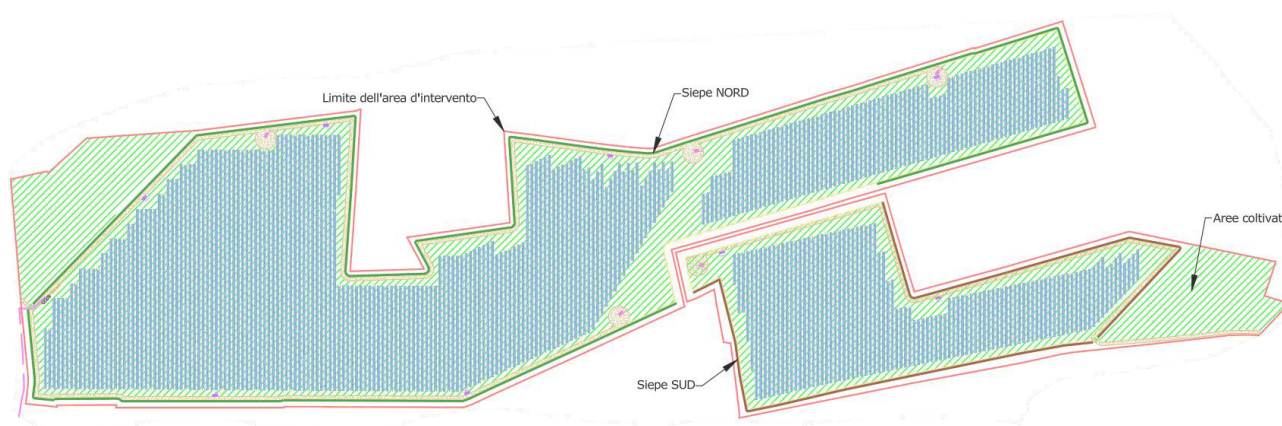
Planimetria generale con andamento delle siepi perimetrali
